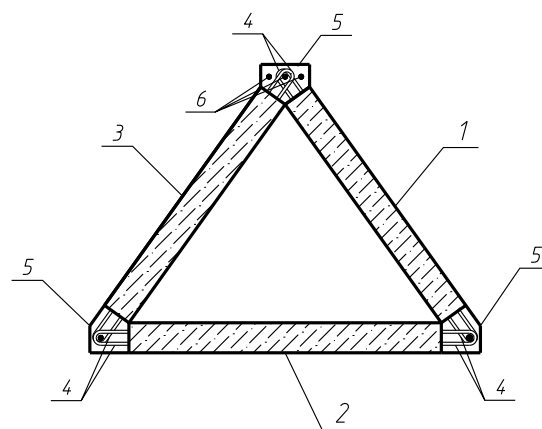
Сечение сборно-монолитной железобетонной балки пологой треугольной формы. 1, 2, 3 грани балки; 4- арматурные выпуски; 5 – монолитные участки; 6 – рабочая арматура
